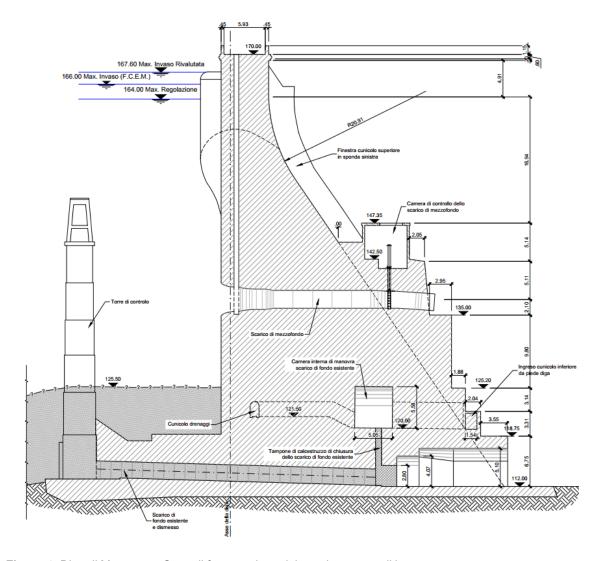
Diga di Muzzone – Stato di fatto: sezione del concio oggetto di intervento.
